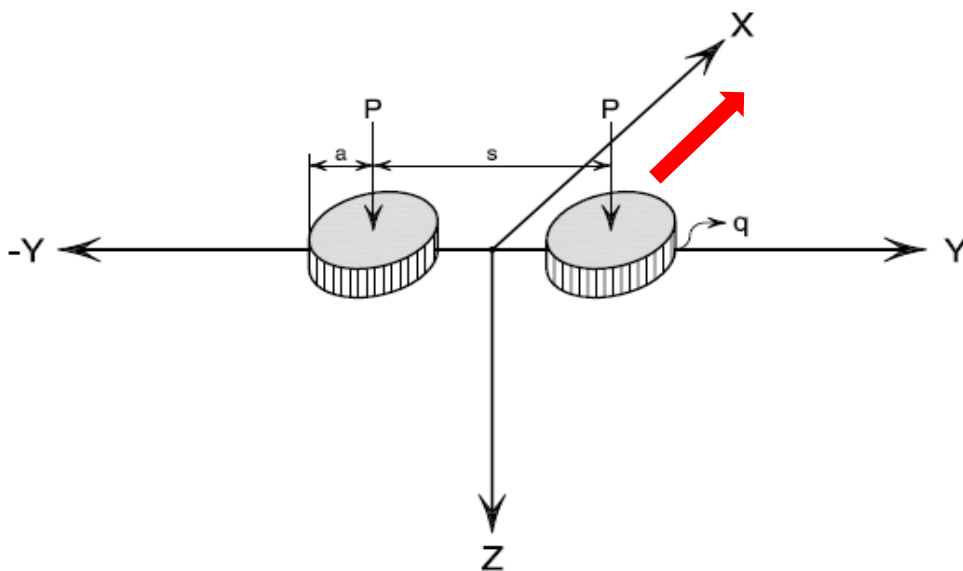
Esquema general del sistema de pavimento multicapa (tridimensional)
